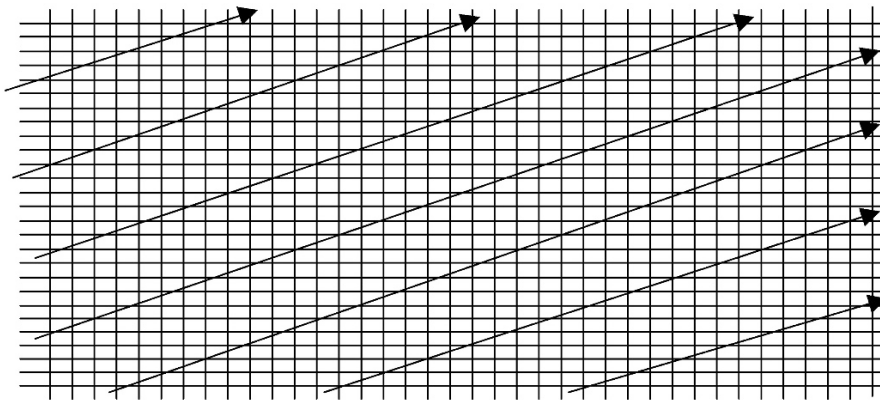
Prinzip des Durchflechtens einer Bewehrungsfläche (die Laufrichtung des Flechters ist immer diagonal!)
